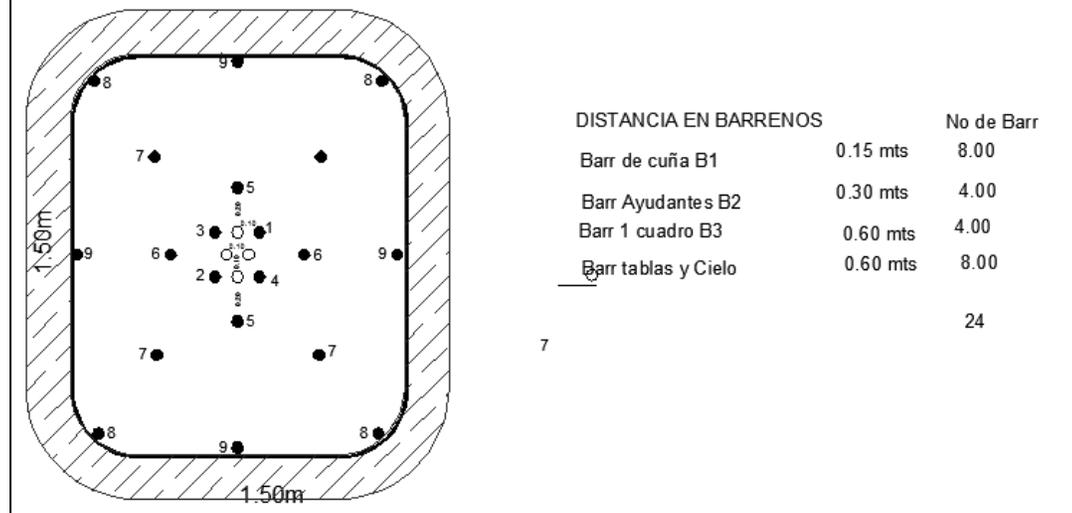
Accesos a Niveles existentes y áreas de explotación, detalles de barrenación rampas general, rebajes y contra pozos.
